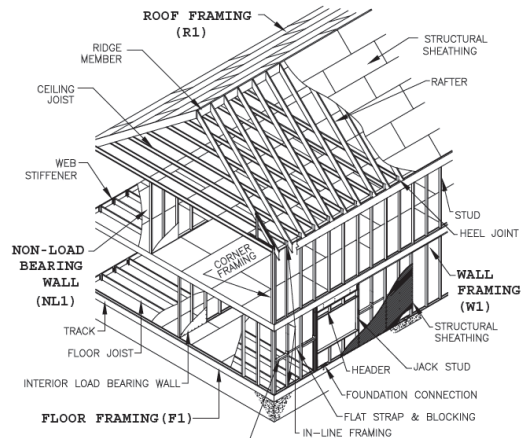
Esquema estructural del sistema Steel Framing. [50]
